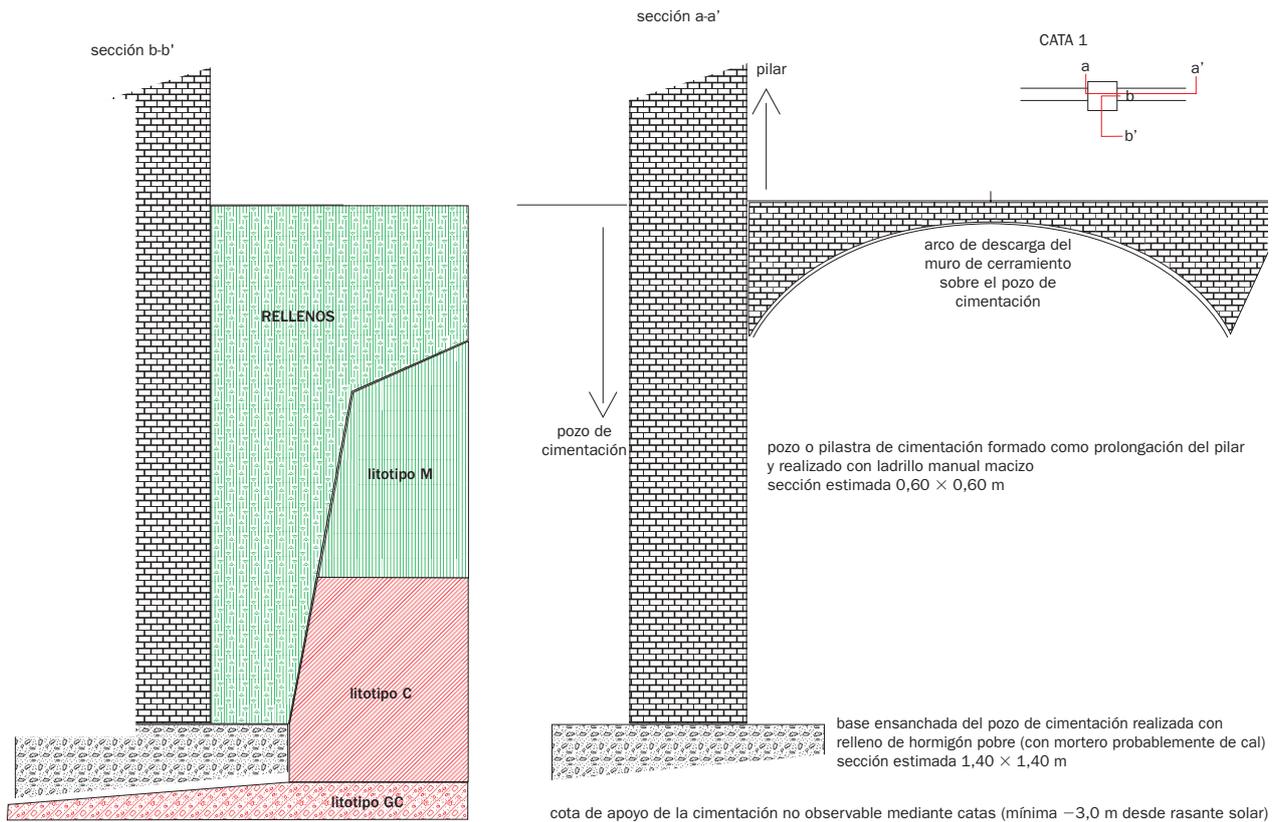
Secció de fonament de façana. | Sección de cimiento de fachada.
